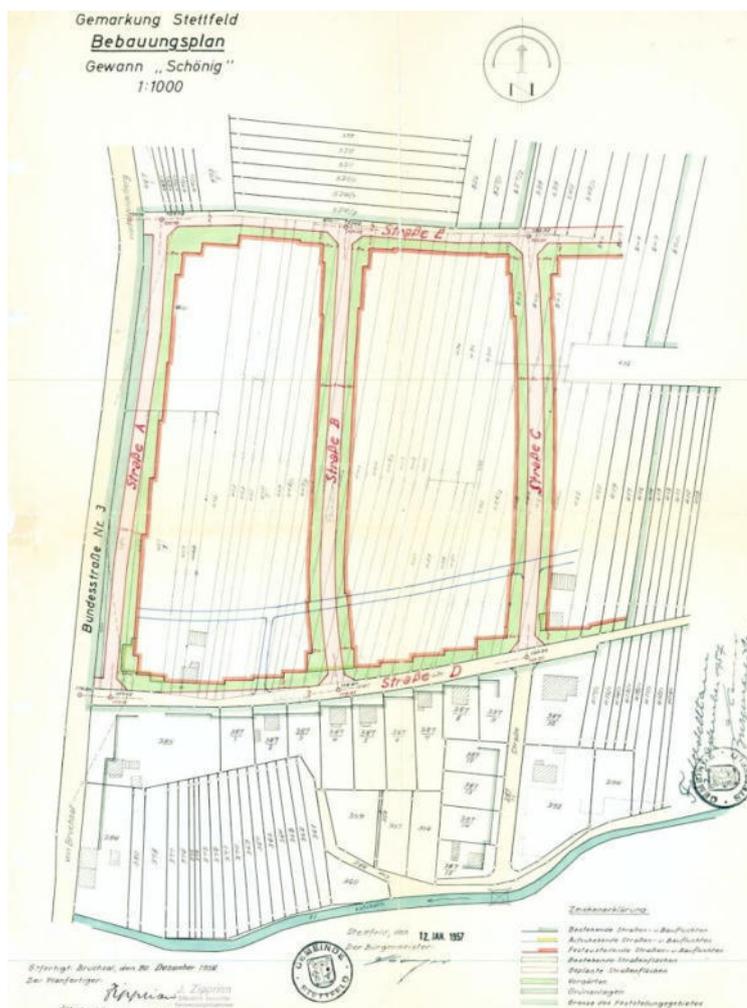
Baufluchtenplan „Bebauungsplan Schöinig“, 1957
